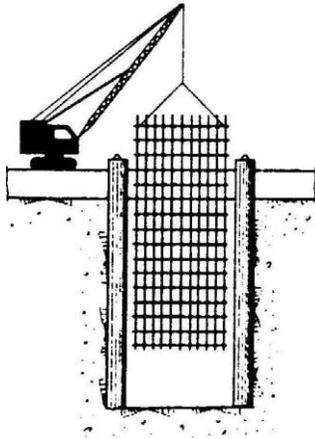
Detalle del izaje de la armadura en el módulo (corte longitudinal).
